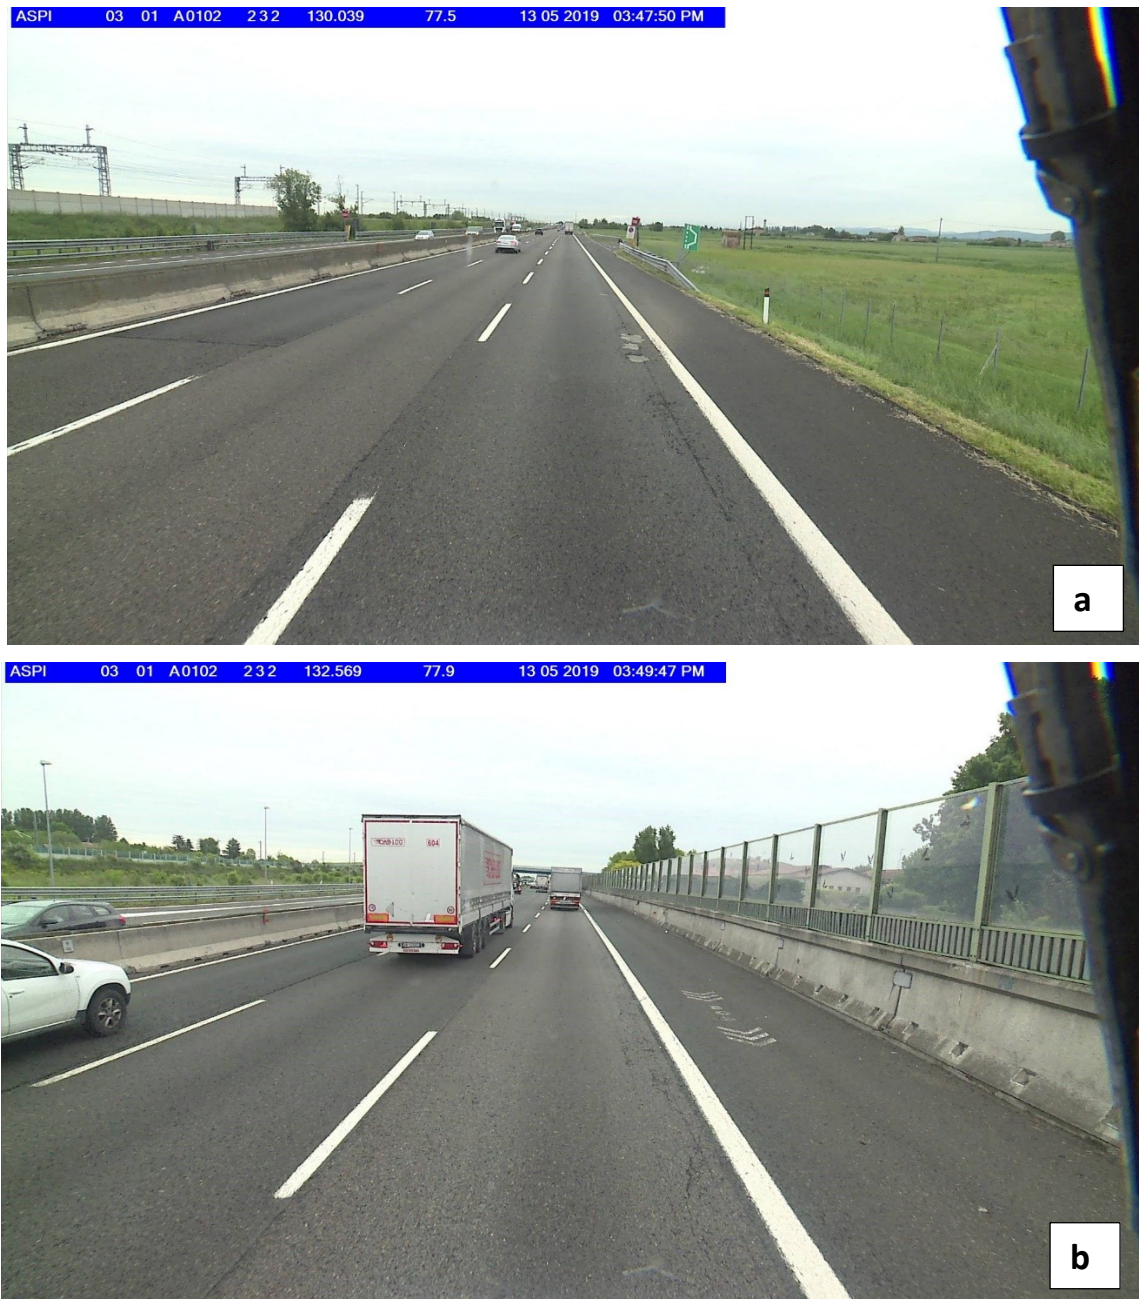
b: giunto di stesa della pavimentazione (stesa della corsia di emergenza)
